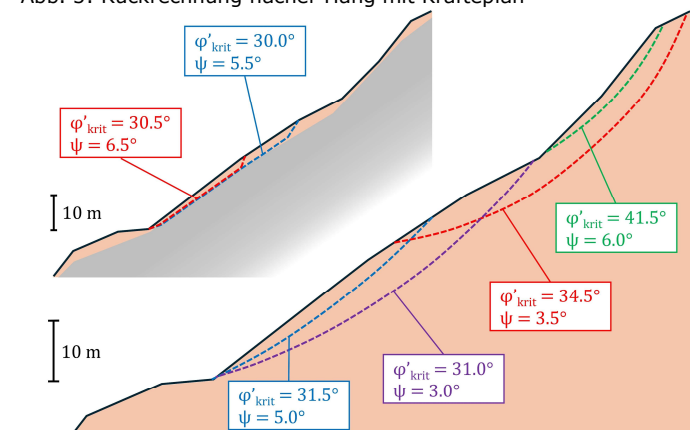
Rückrechnungen steiler Hang mit und ohne Felsoberfläche
